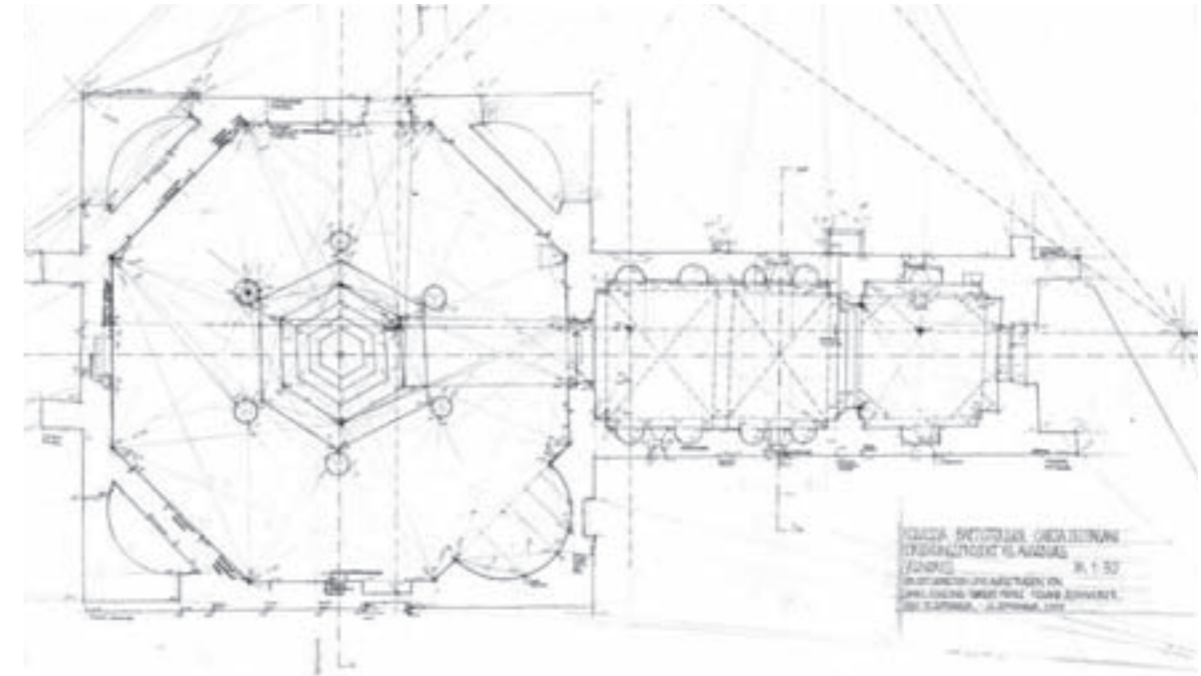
Aquileia, Baptisterium und Chiesa dei Pagani, Grundriss Erdgeschoss, Bauaufnahme, HS Augsburg 2009/10, Originalmaßstab M 1:50.
